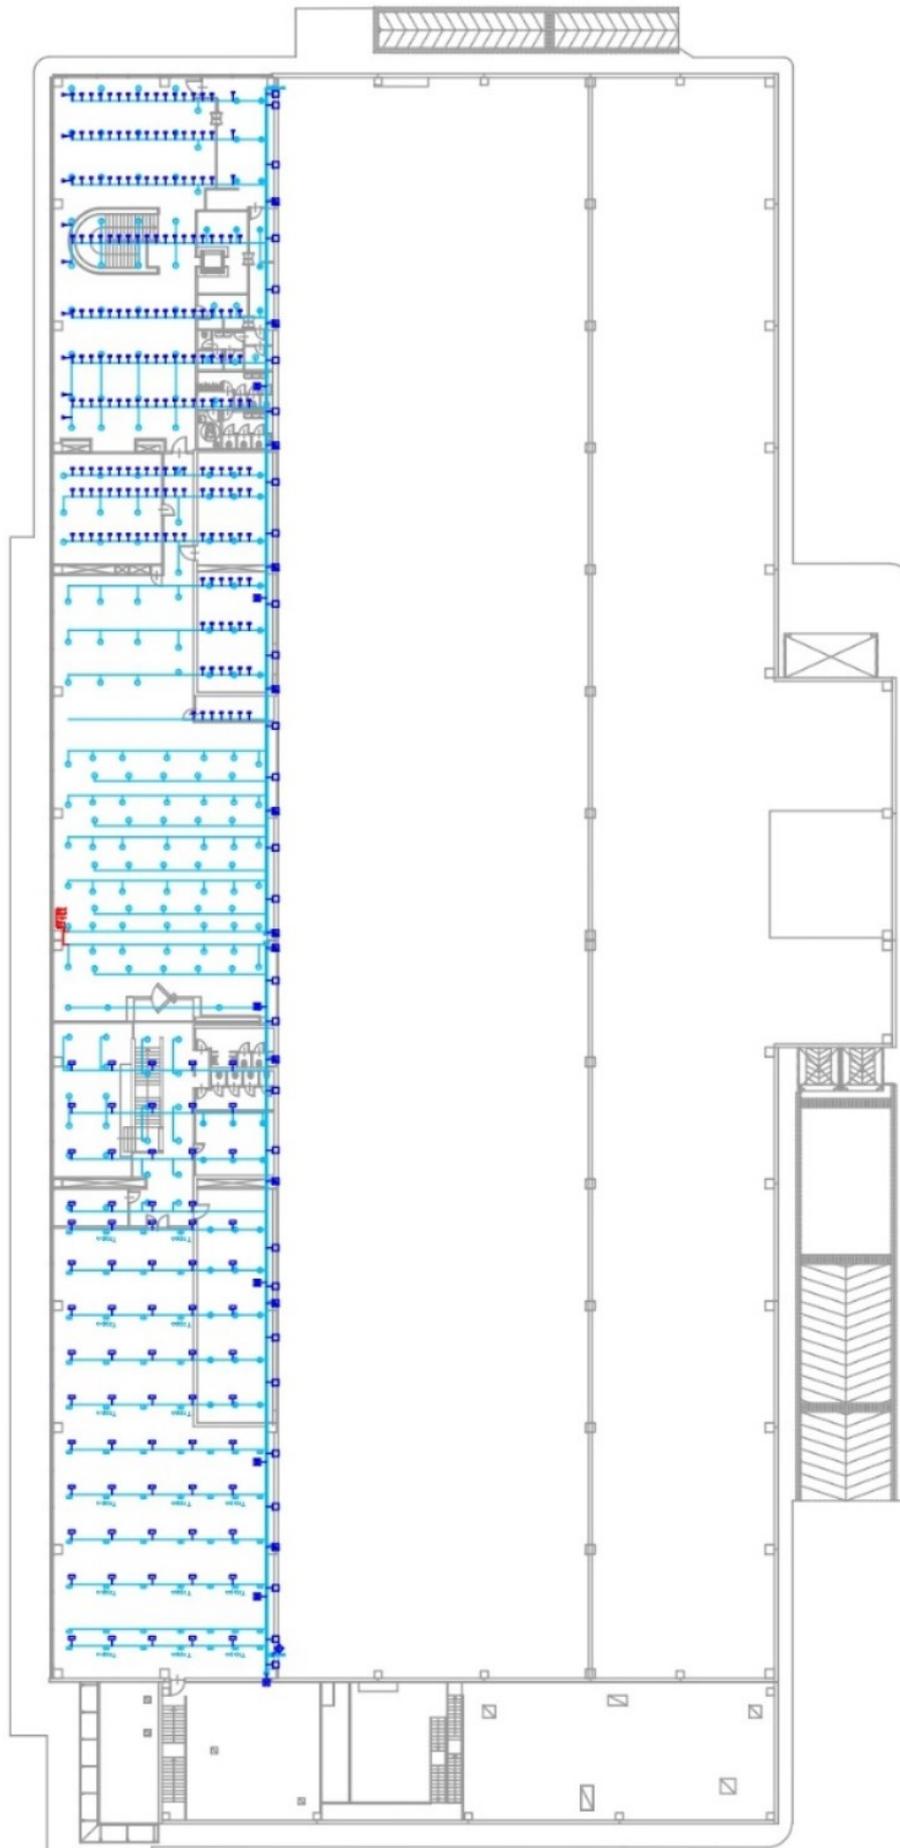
Planimetria sprinkler piano primo zona uffici
